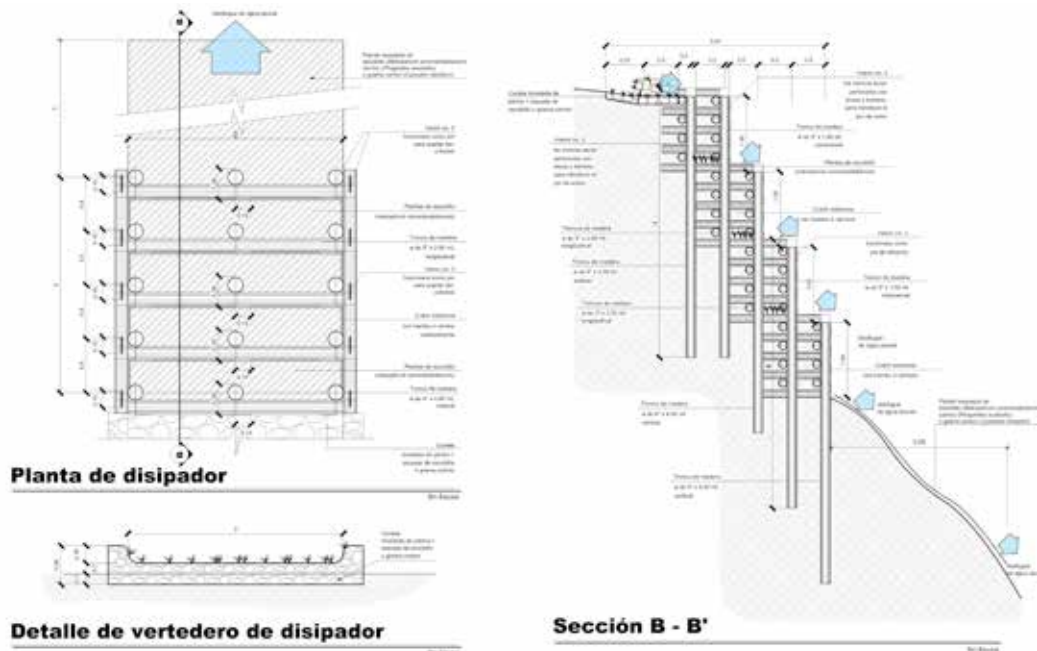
Detalle disipador. Sección B-B'. Planificación Obra ORCC-01/RD-SOL-08.
